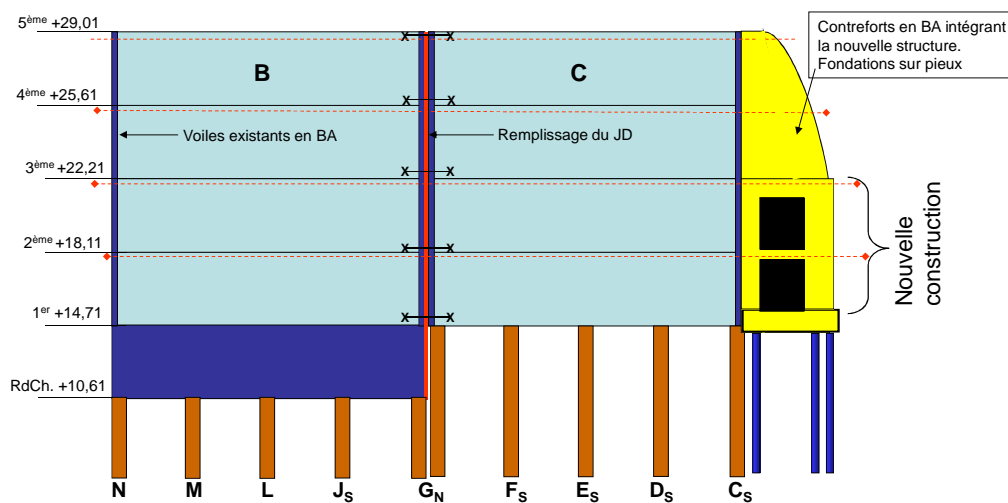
Coupe longitudinale avec le renforcement par contreforts
